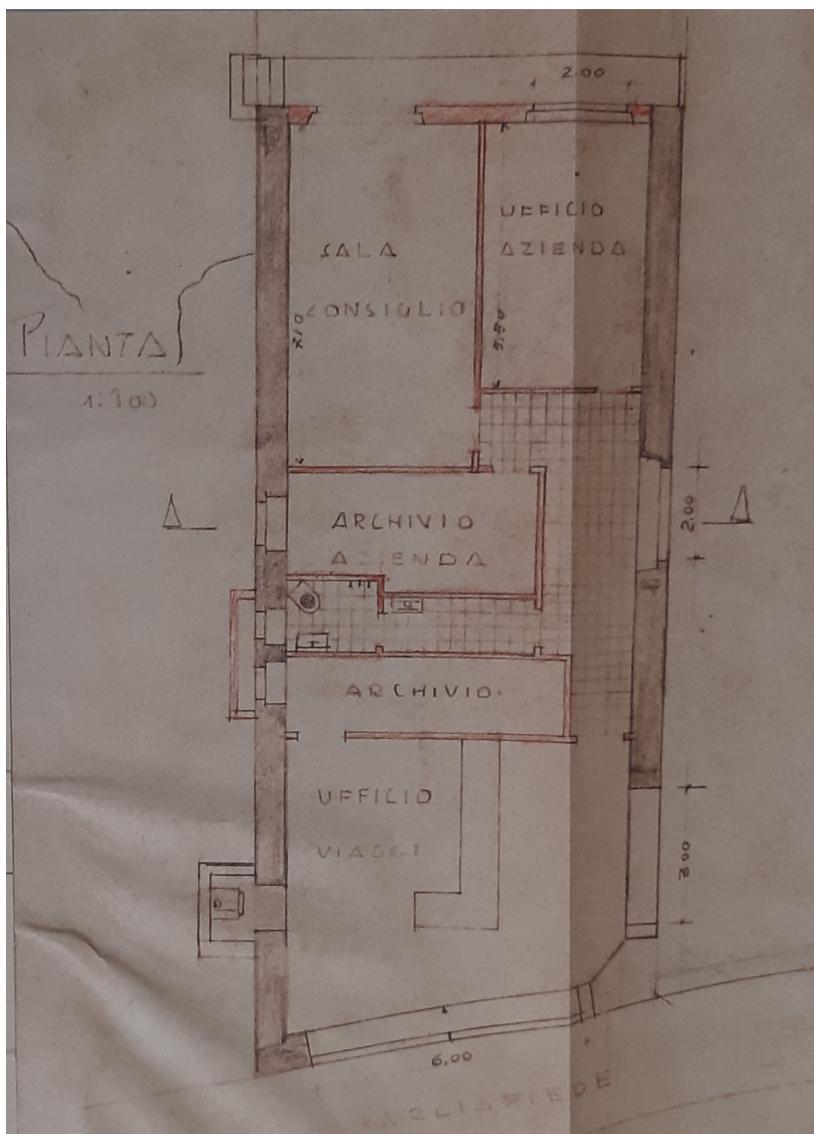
Estratto del progetto di modifica della darsena per la creazione dei locali ad uso dell'Agenzia Autonoma di Soggiorno. Planimetria di progetto (ASVb, Comune di Pallanza, Licenza Edilizia, b 63, fac. 1, 1959).
